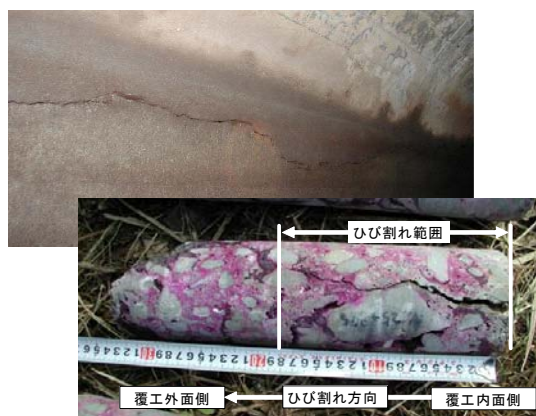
ひび割れ状況とひび割れ部から抜いたコア
